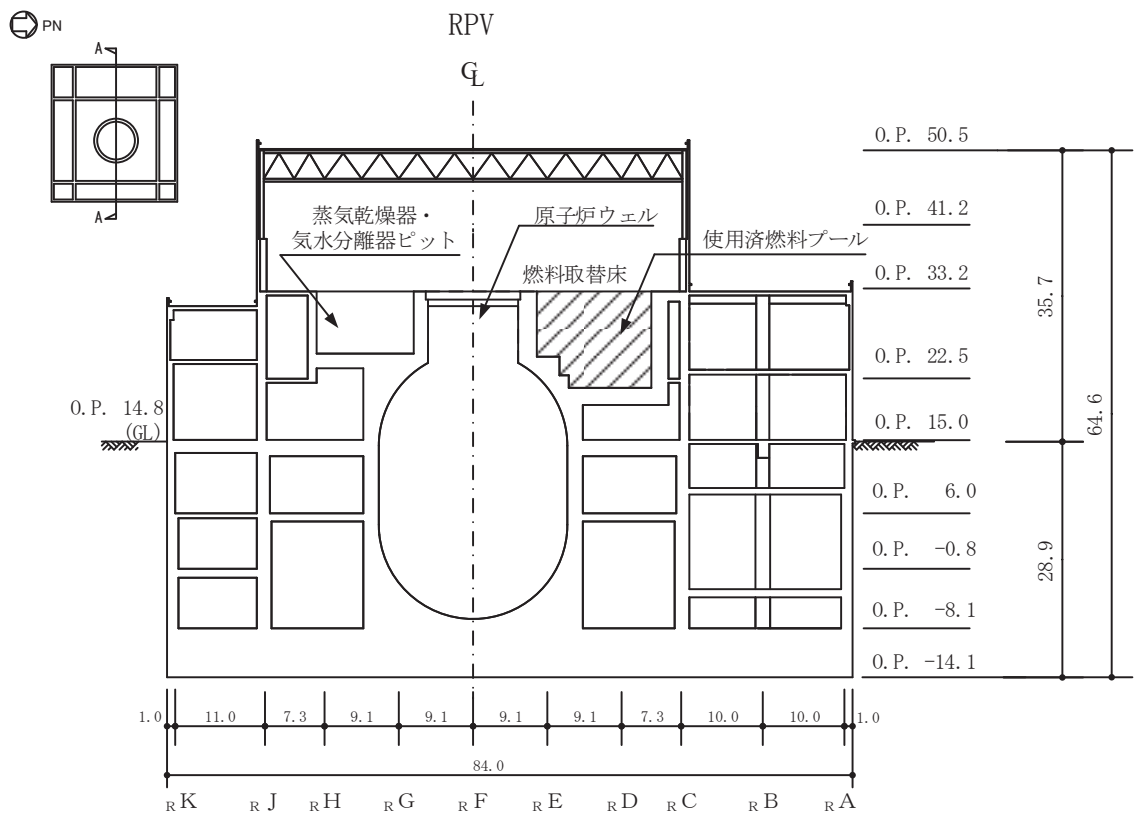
使用済燃料プールを含む原子炉建屋の概略断面図
